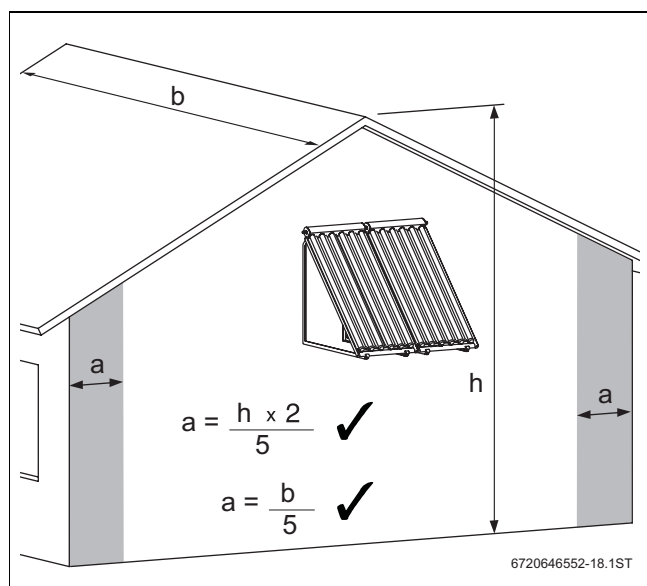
Mindestabstand zum Seitenrand (Maß a) bei Fassadenmontage, beide Formeln sind anwendbar
